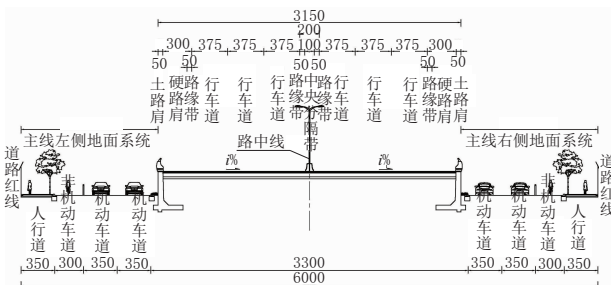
福宜高速城区段宽 60 m 标准横断面图(单位:cm)
